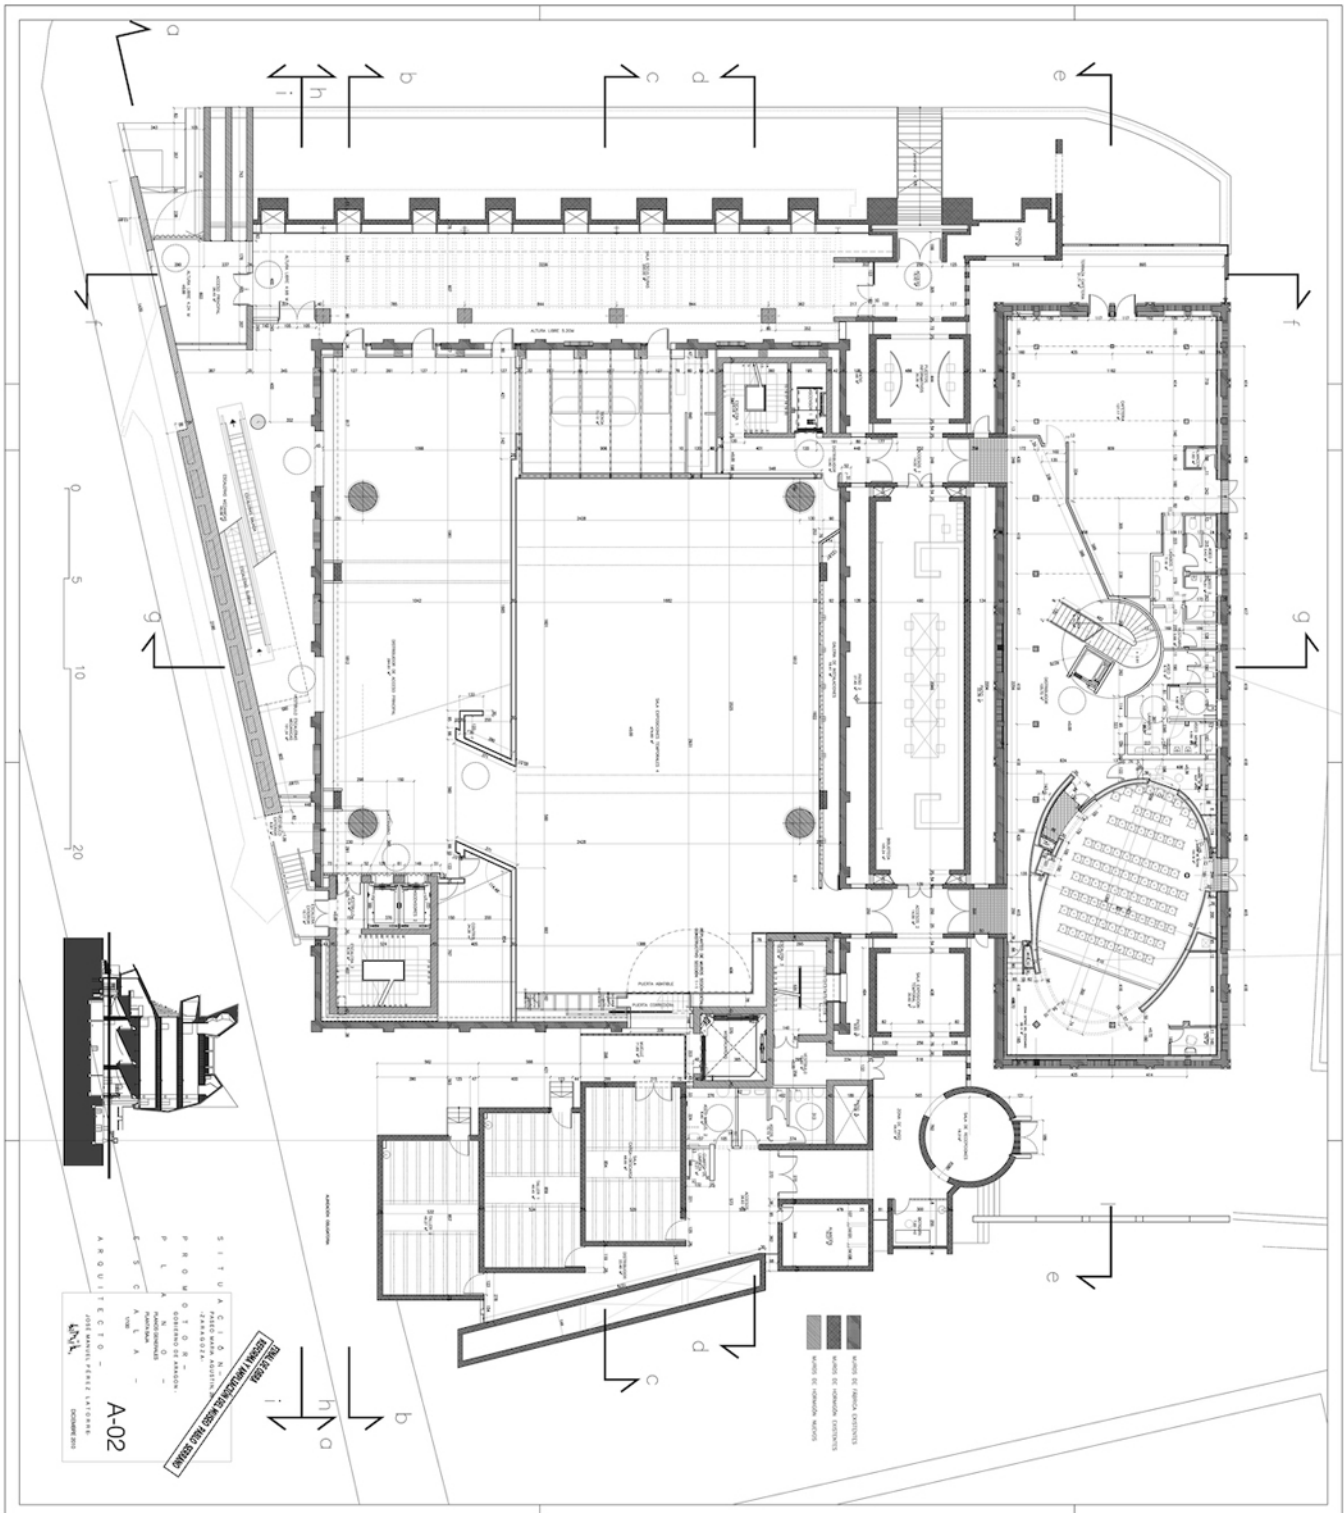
Planta baja (según J.M. Pérez Latorre)
